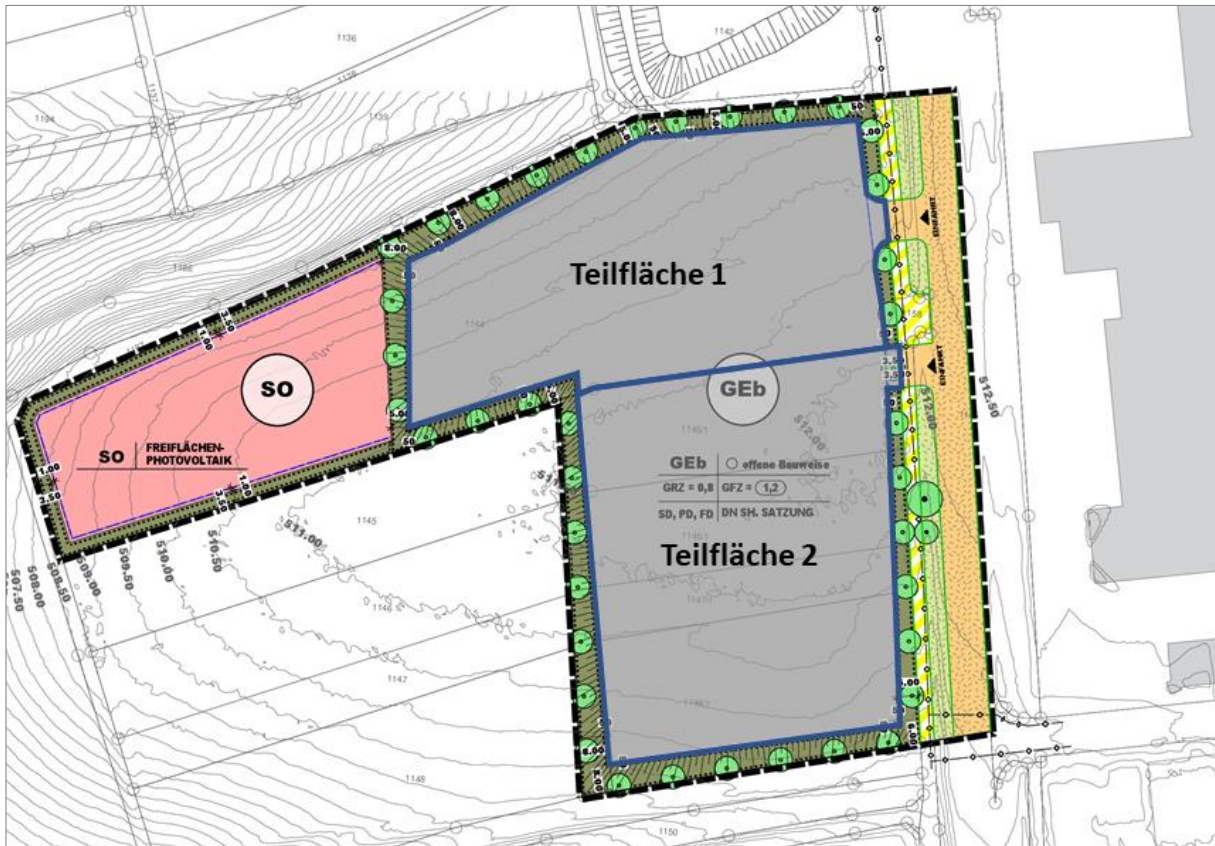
Planzeichnung des zu untersuchenden Bebauungsplans
